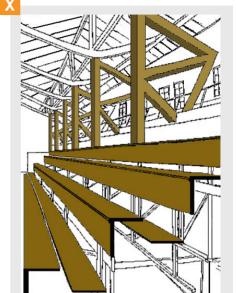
Estructura de soporte de cubierta y graderías reticuladas, podría permitir trepar a cielo de recinto, así como la ocurrencia de acciones indebidas bajo las graderías.
